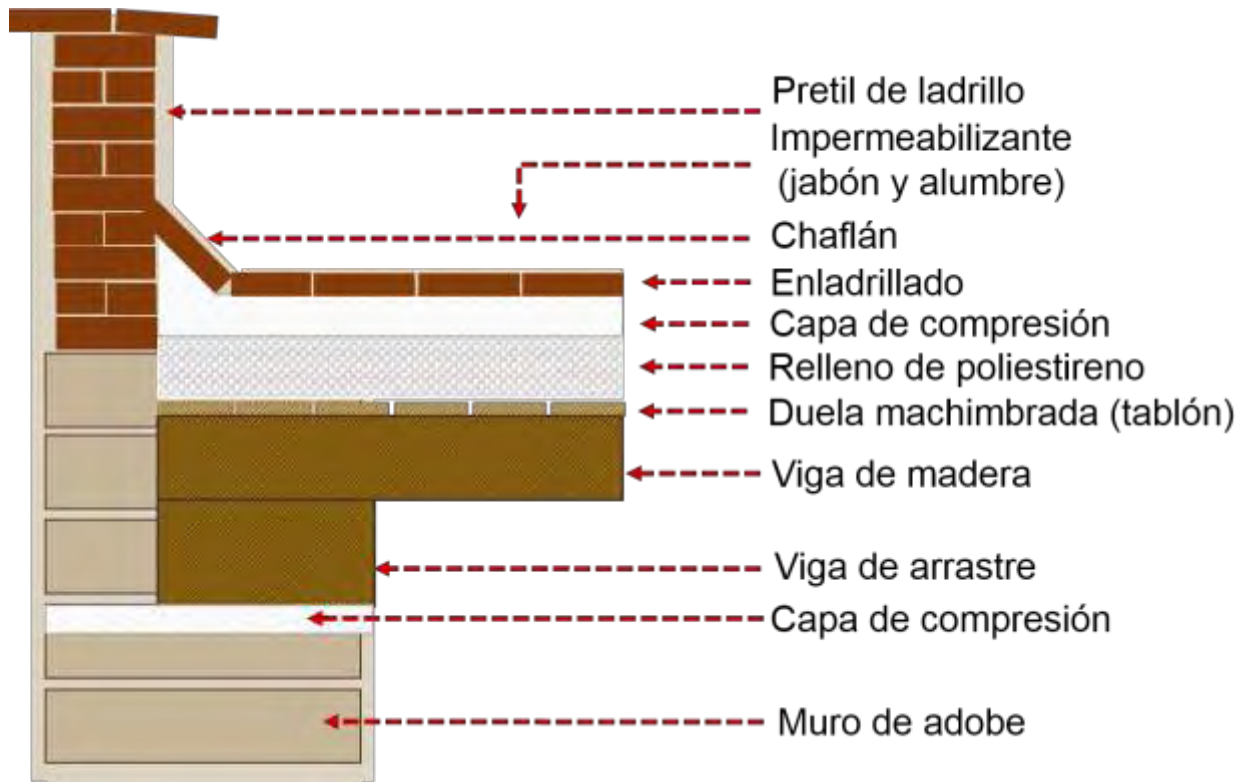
Detalle de pretil y cubierta segunda propuesta.
